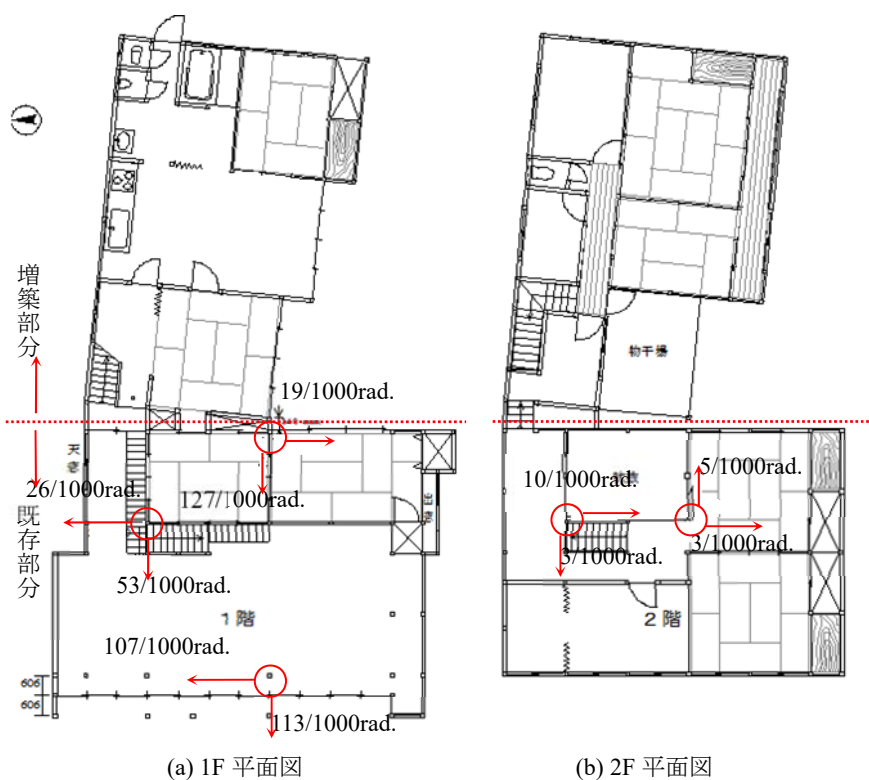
B 邸の平面図 (図中の数字は残留変形)
